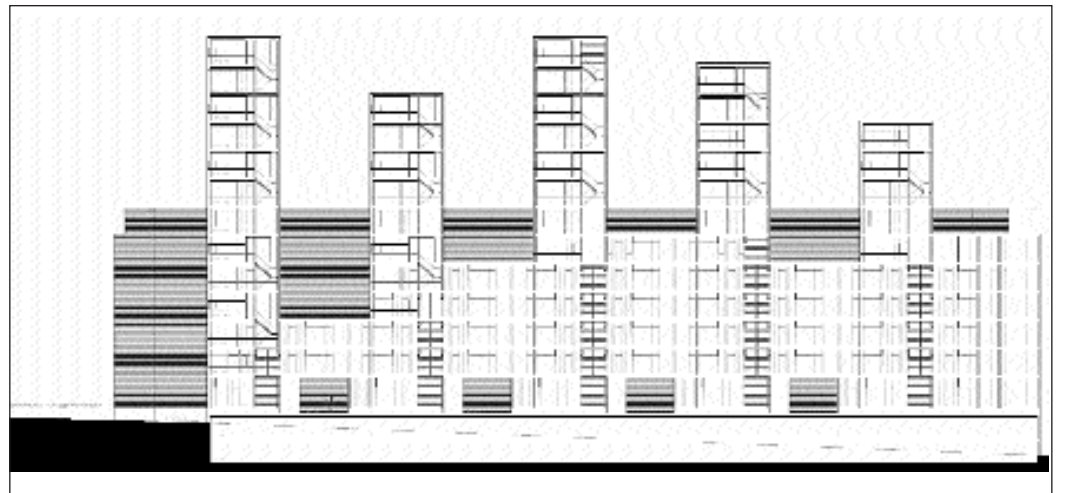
Bloque cerrado de tipología mixta. Arqs. Espejel, Miranda y González (en Villaverde Bajo). Boceto presentado al concurso.
